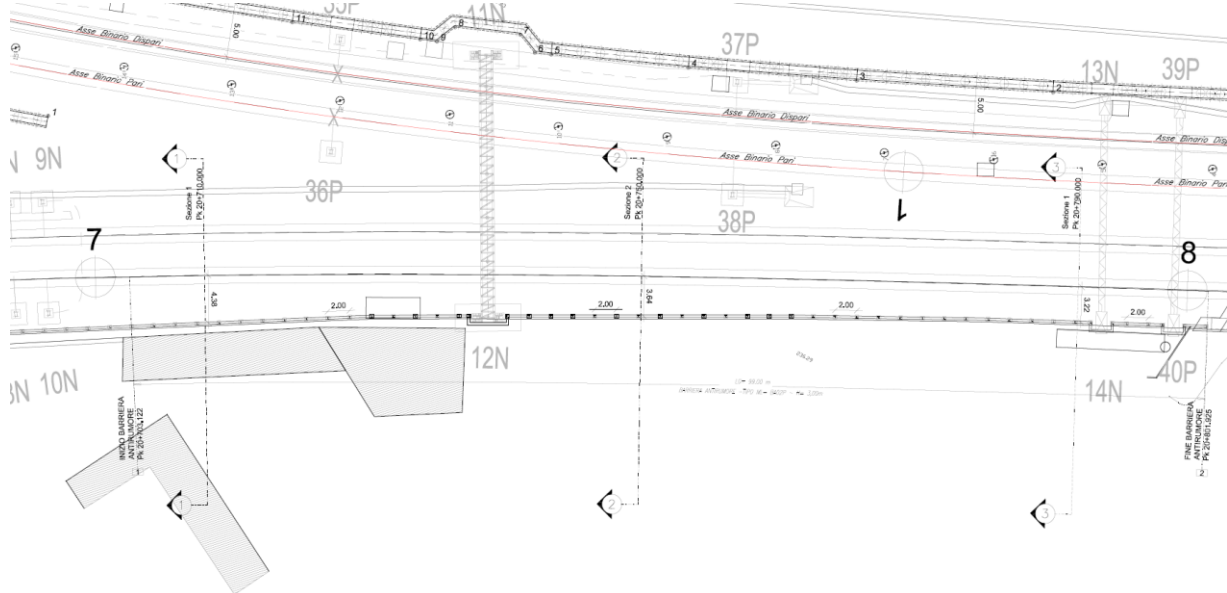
Stralcio planimetrico della barriera ML BA02 P
